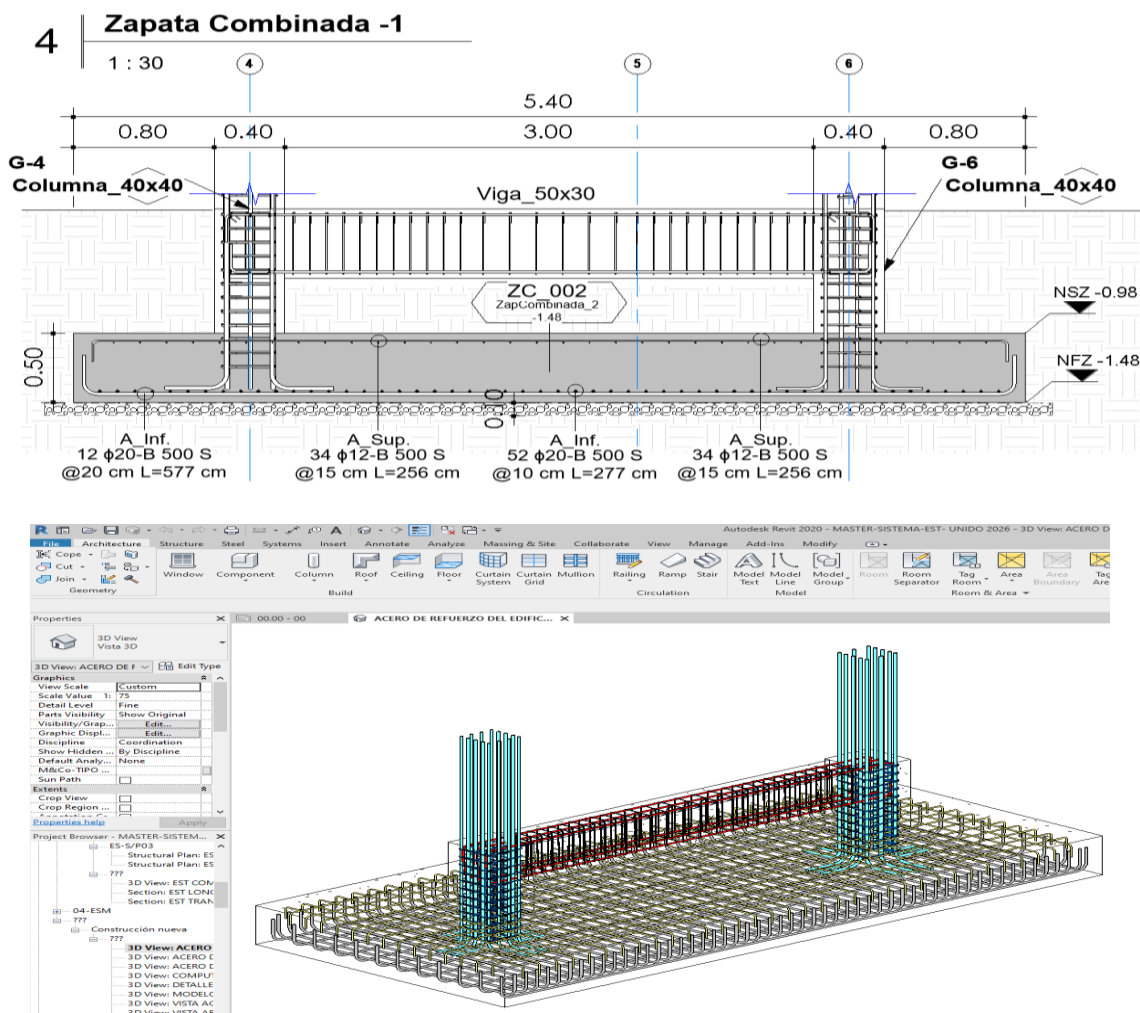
Despiece Zapata Combinada Hormigone Armado (Modelo Federado)
